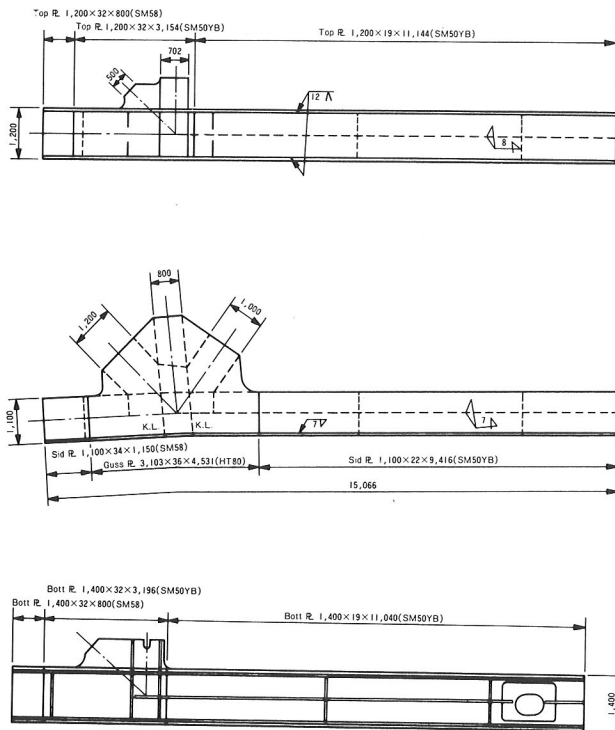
番ノ州高架橋トラス溶接施工試験体
